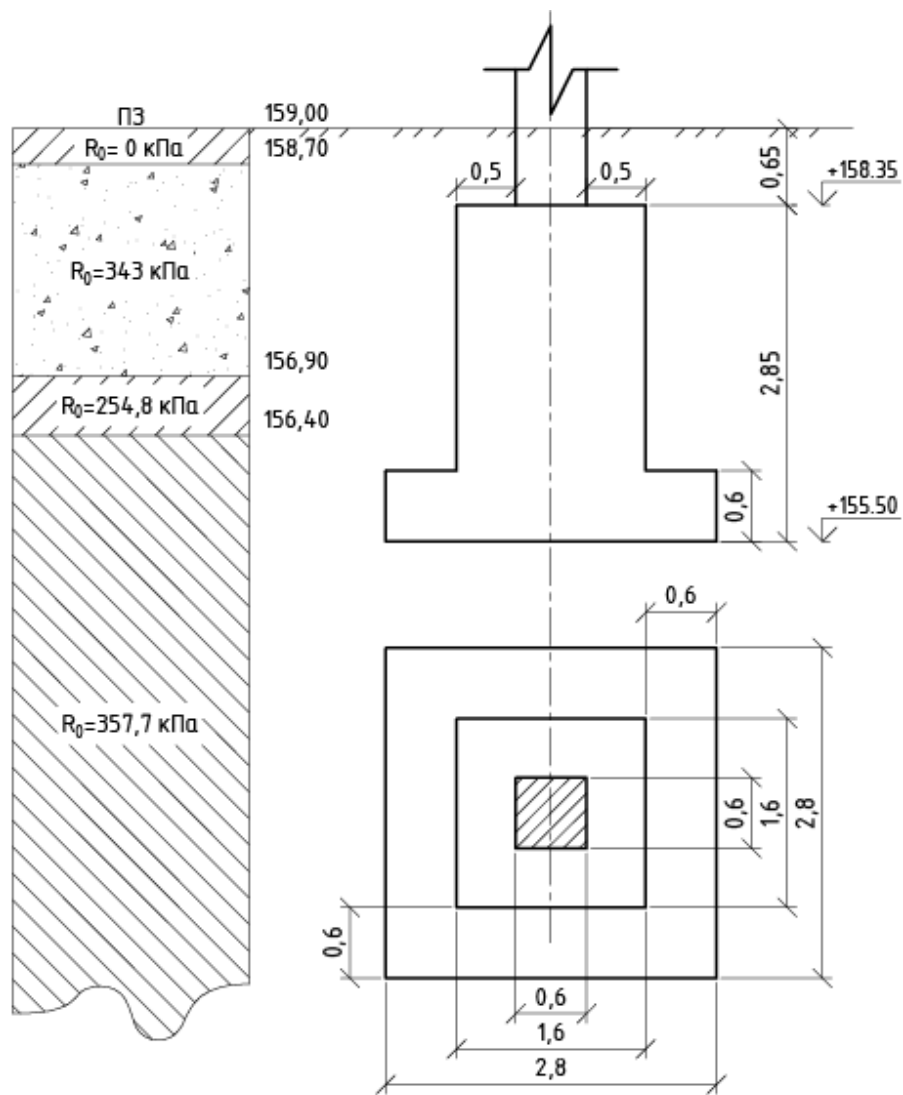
Схема до розрахунку фундаменту мілкового закладання
